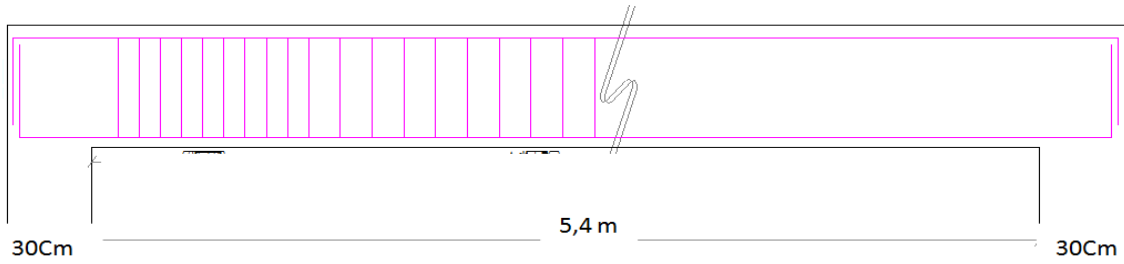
Croquis de ferrailage des poutres (L=6m)
